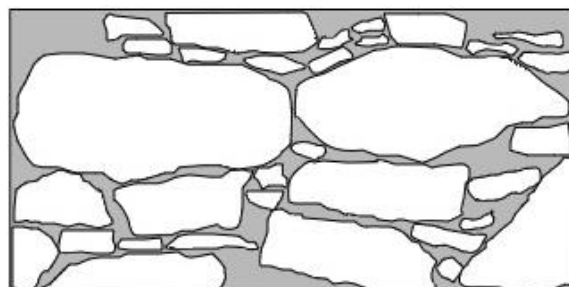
Vista del paramento de un posible recinto en el lado sur de Umashuko. Dibujo a detalle de la mampostería del muro.
